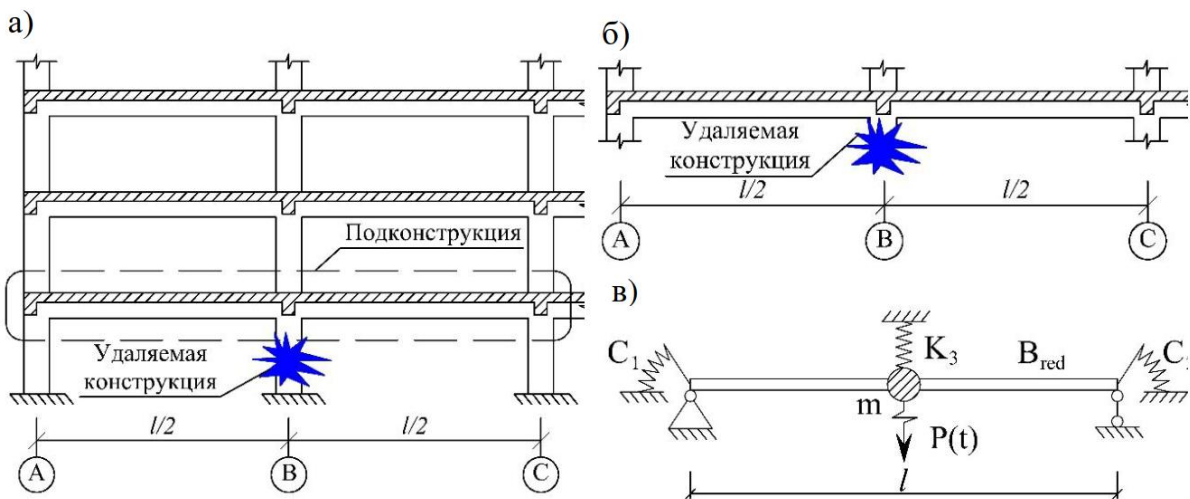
Зона локального разрушения (а), выделенная подконструкция (б) и расчетная схема (в)
